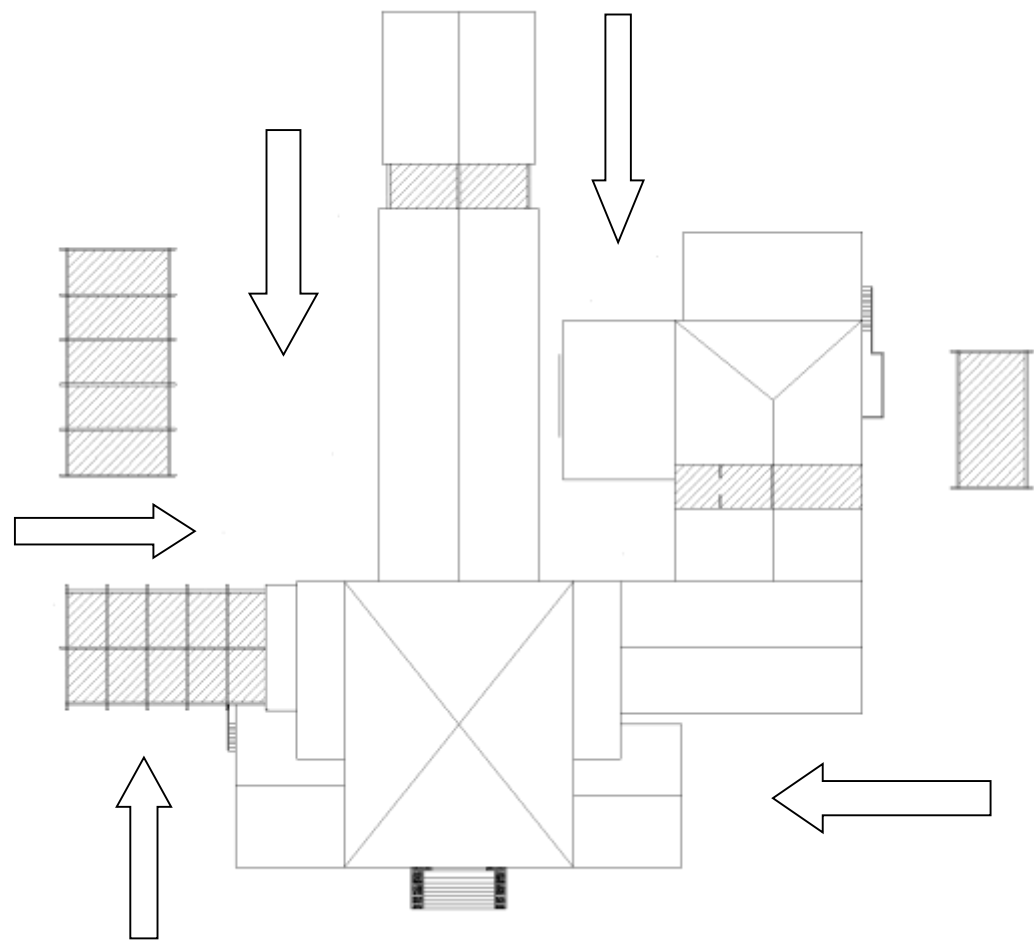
Implantación del conjunto, facilidad de acceso desde cualquier punto a la edificación.
